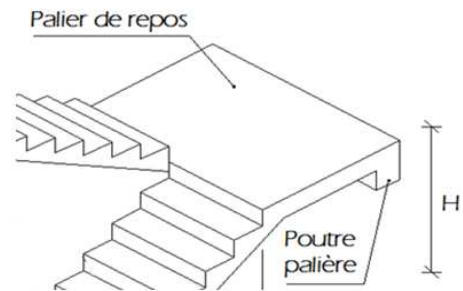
Coupe schématique d'un palier intermédiaire.
